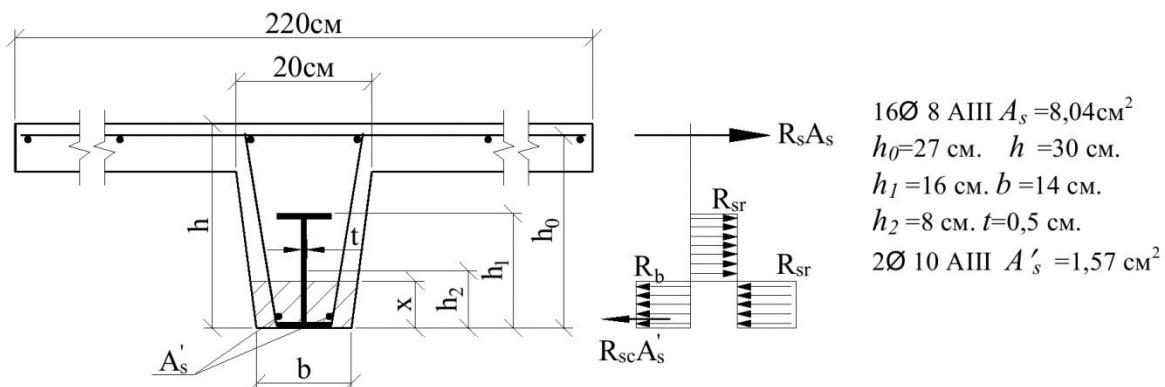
Расчетная схема балки при расчете на отрицательный момент
